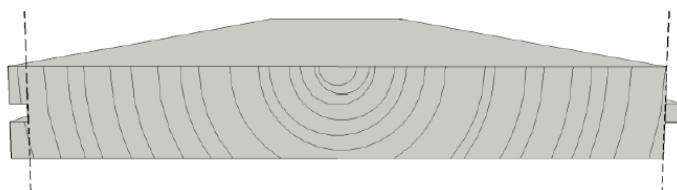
Sezione tipo di una tavola di "perlinato strutturale".
